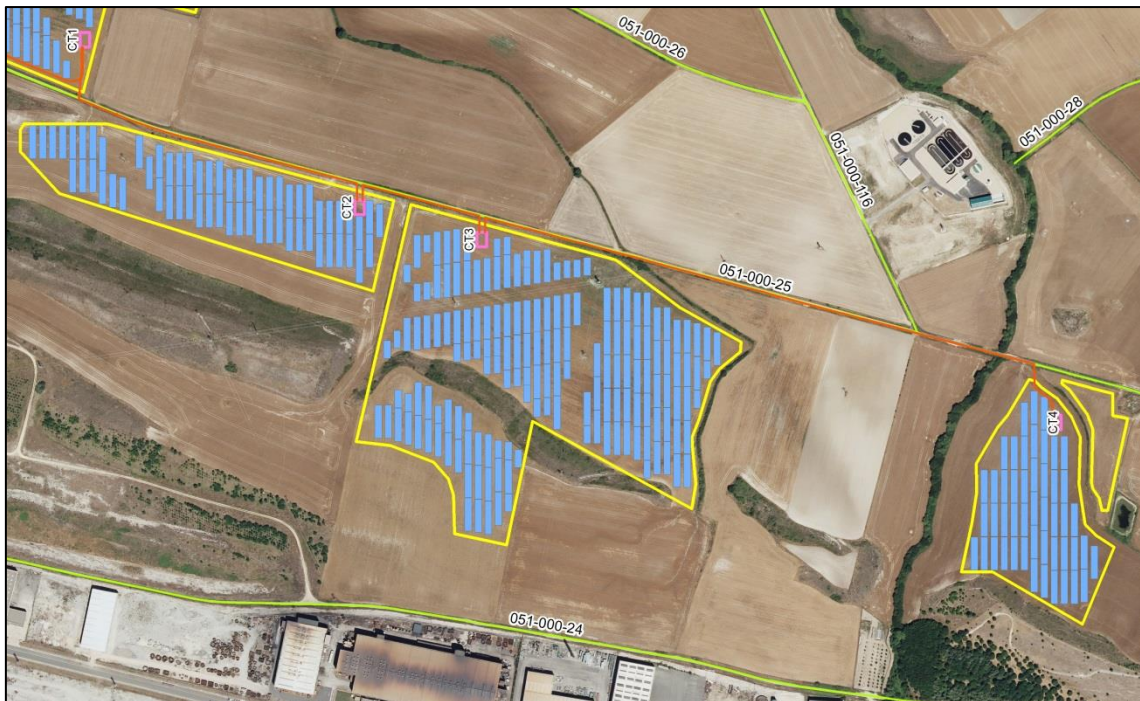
Detalle de las zanjas del cableado de media tensión.
